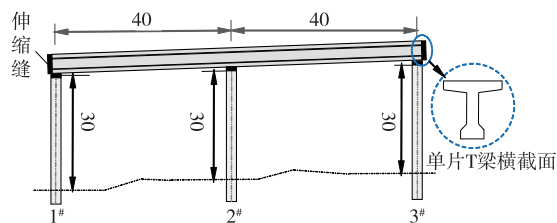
某高速公路桥梁 T 梁计算模型示意图(单位:m)
